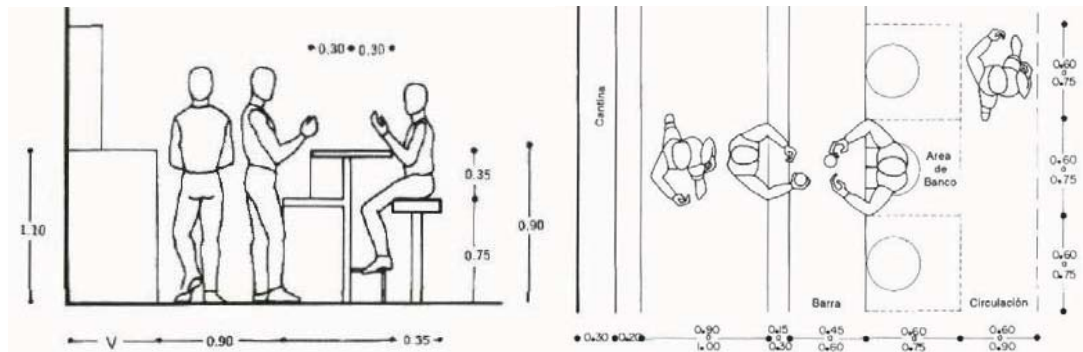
Alzado y planta de barras de servicio y autoservicio en locales de alimentos.
